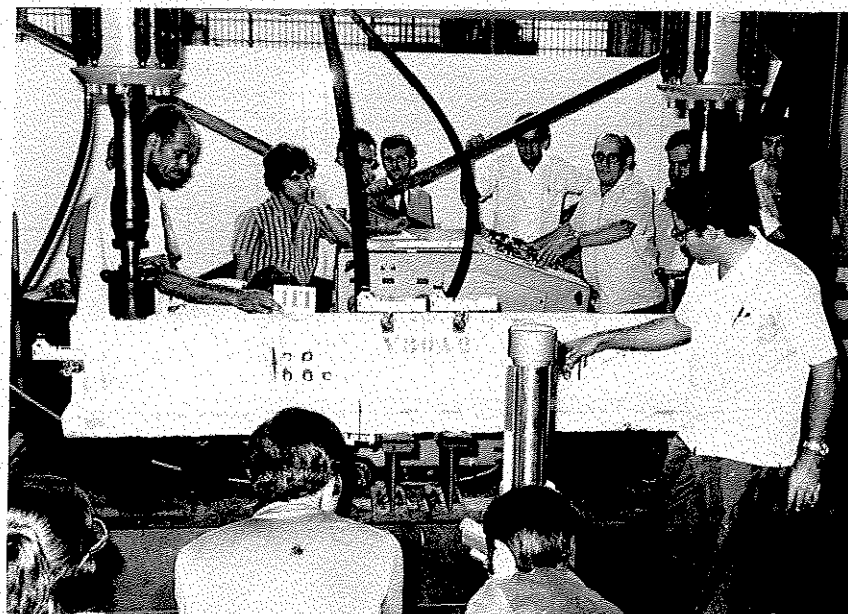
Viga V30A* com a armadura transversal escoando.
